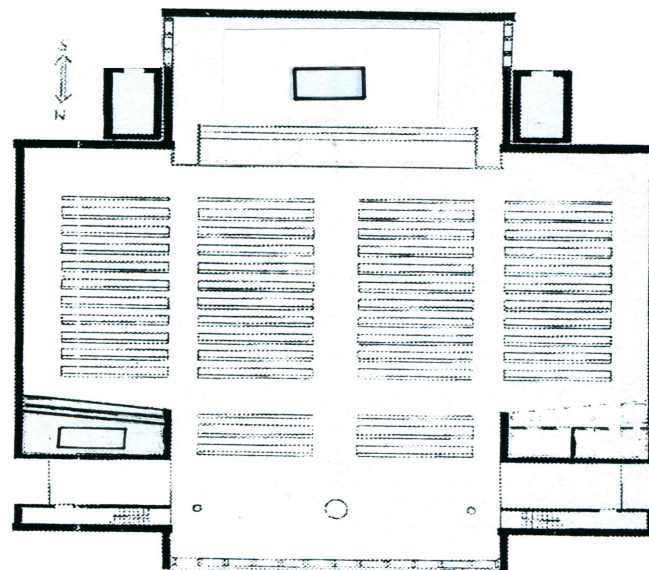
Grundriss der Pfarrkirche, 1956
